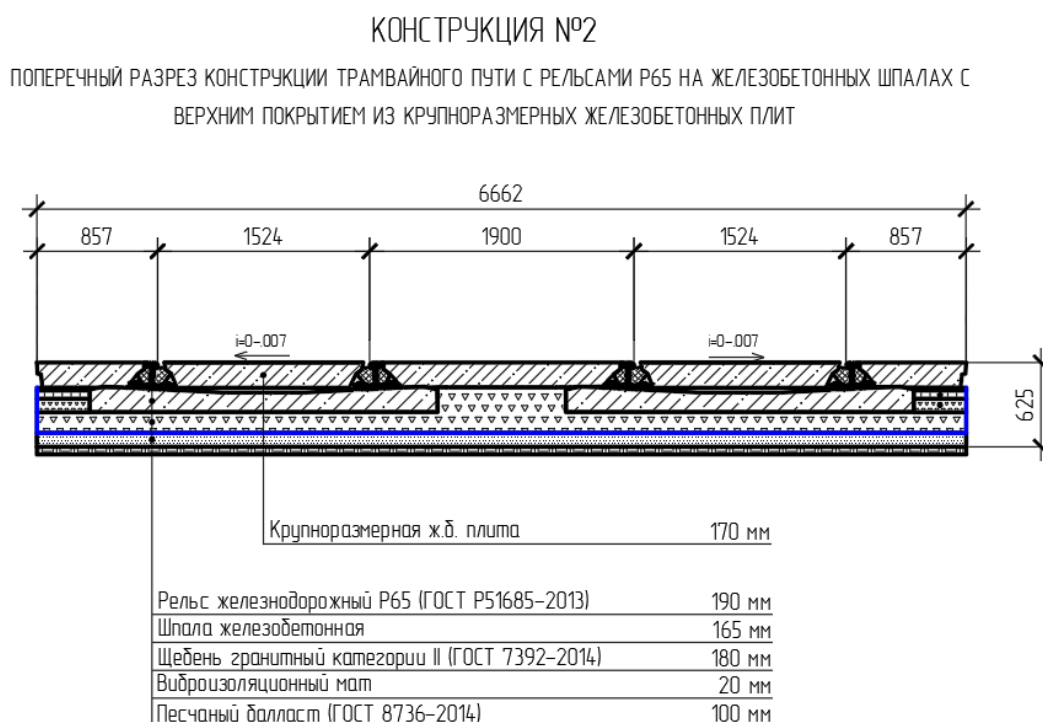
Поперечный разрез конструкции трамвайного пути с рельсами Р65 с верхним покрытием из крупноразмерных железобетонных плит
